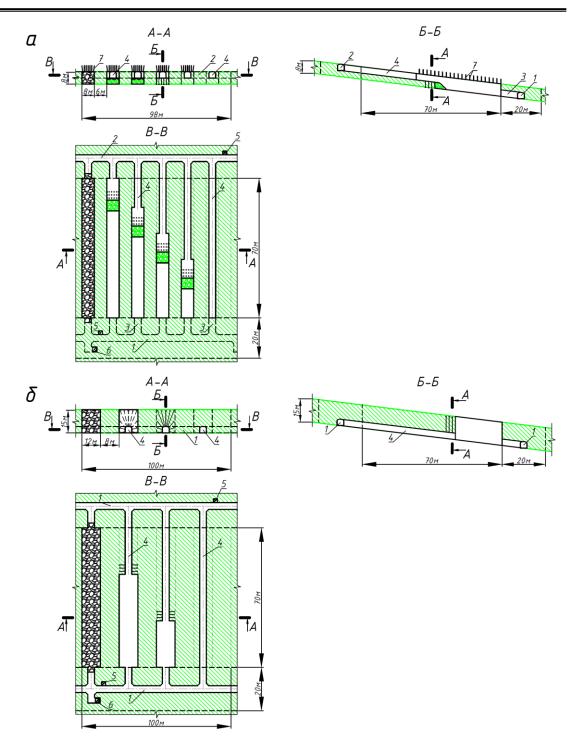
Камерно-столбовая система разработки: а) вариант 2.1; б) вариант 2.2: I — доставочный штрек; 2 — вентиляционный штрек; 3 — погрузочный орт; 4 — буро-вентиляционный (буро-доставочный) орт; 5 — BXB; 6 — рудоспуск; 7 — железобетонные анкеры
